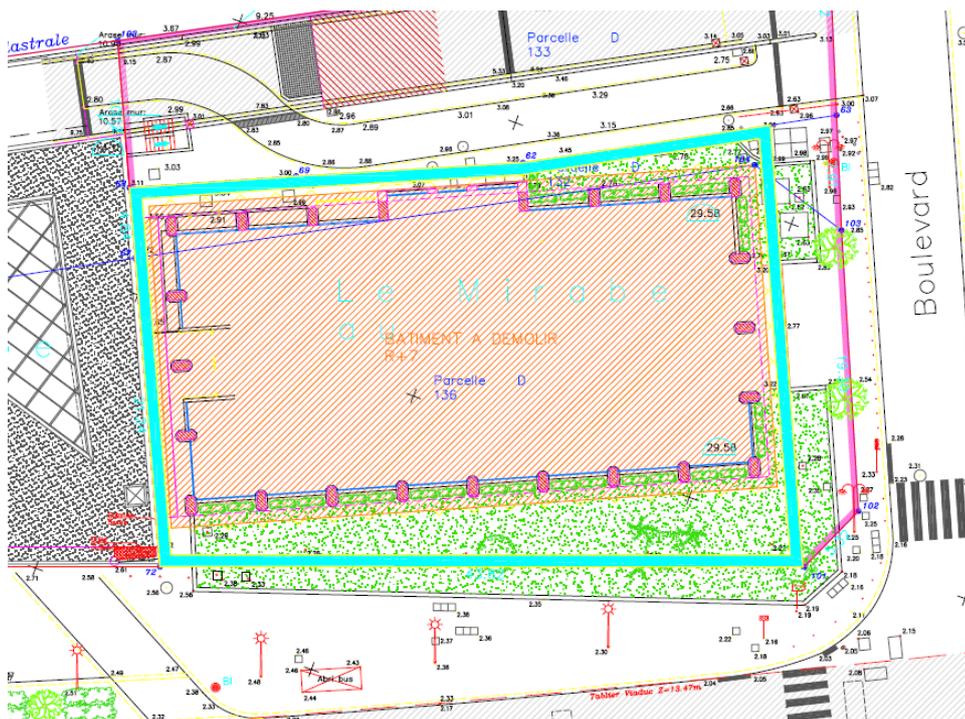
Emprise de la paroi moulée prévue sur fond de plan actuel
